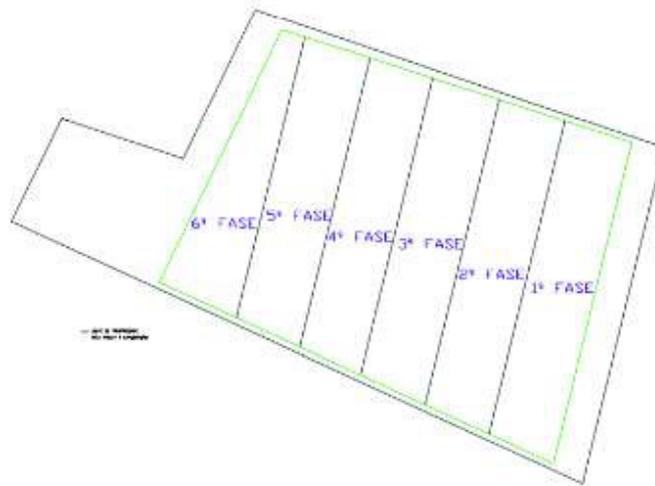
Plano de faseamento de lavra e de recuperação paisagística
